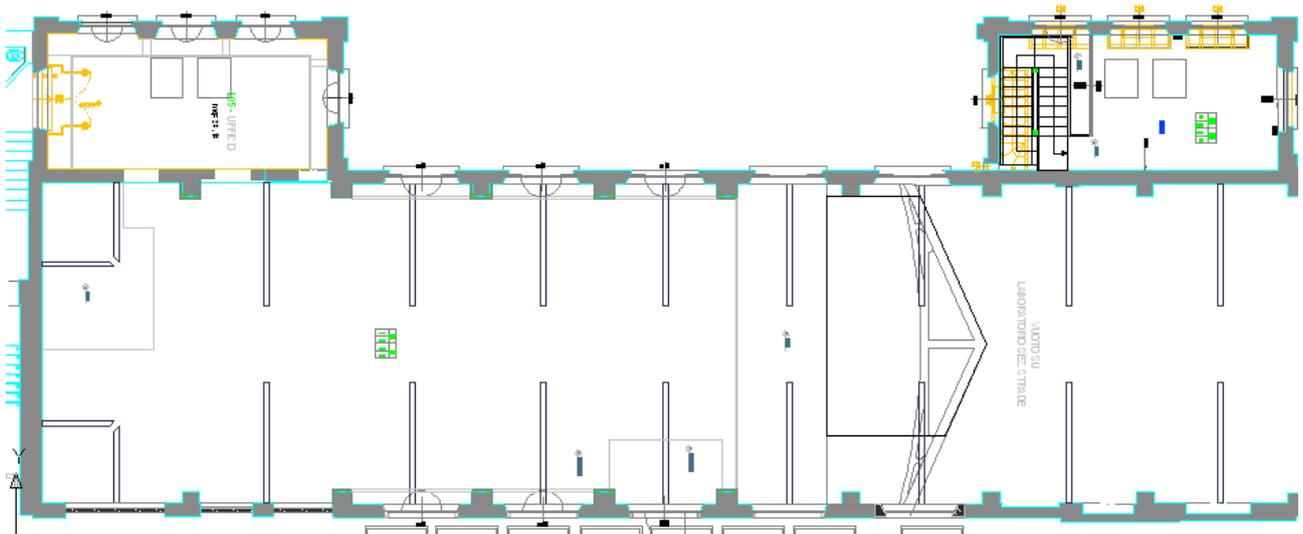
Stralcio della pianta piano soppalco zona Nord.
